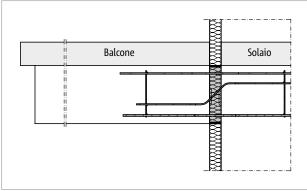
Schöck Isokorb® T tipo BP: balcone con travi a sbalzo (balcone prefabbricato)
